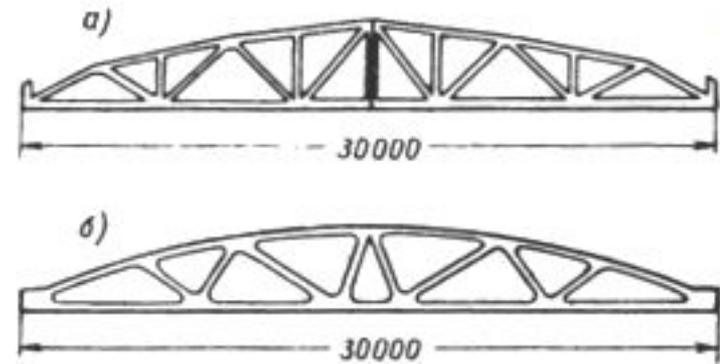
Сборные железобетонные фермы. а — составная; б — цельная предварительно напряженная.
